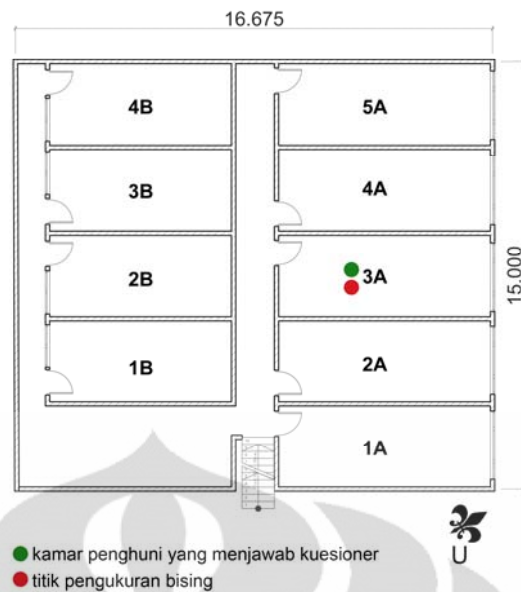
4: Denah Lantai 2 Pondok Kukusan Pria
